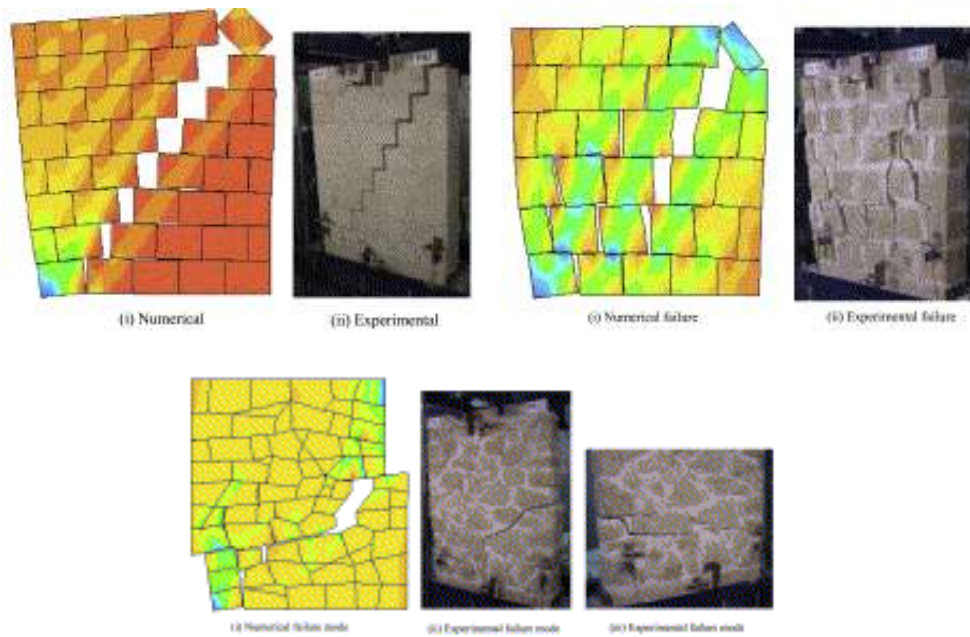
Comportamiento de mamposterías sujetas a cargas laterales paralelas al plano (Senthivel, 2009). En orden mampostería sin juntas de mortero, mampostería con juntas de mortero y mampostería con juntas de mortero en bloques irregulares.
